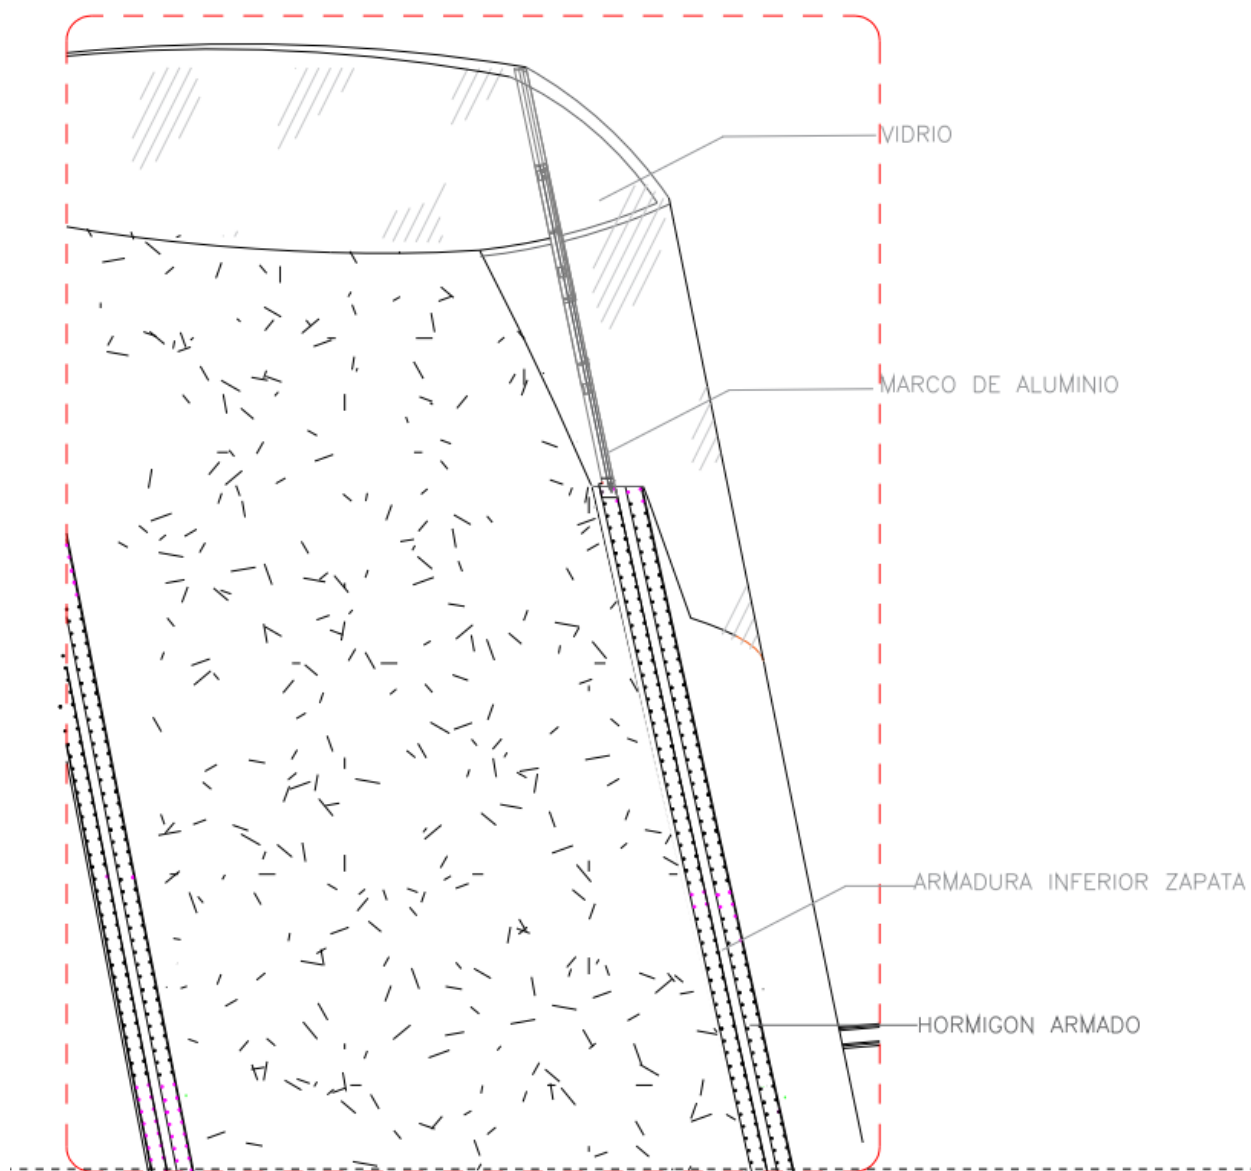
Detalle estructura vacíos de luz Elaboración propia.
